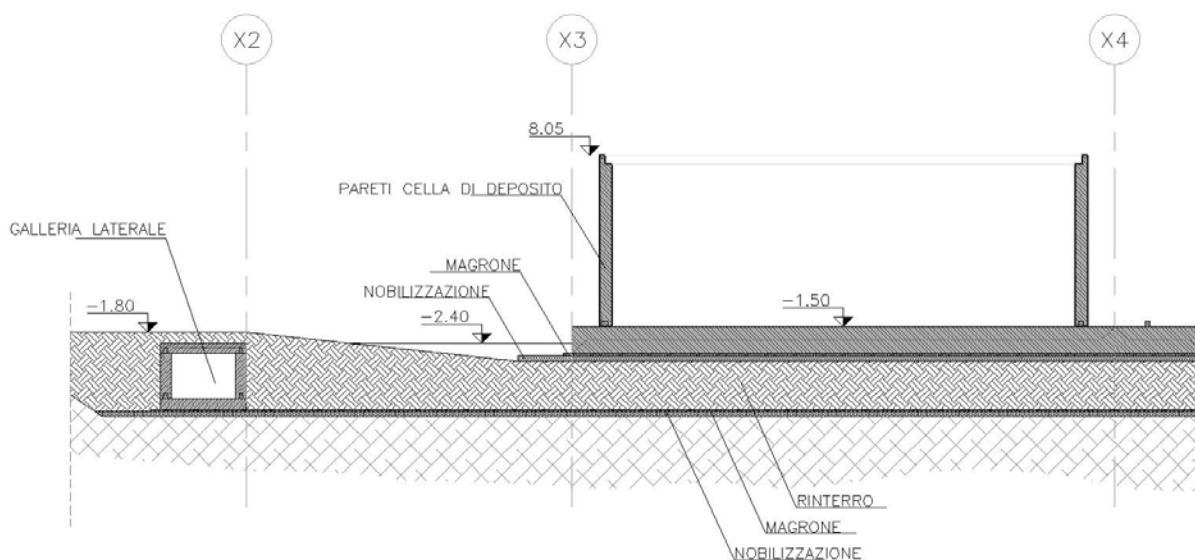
Sezione longitudinale pareti verticali Celle di Deposito
